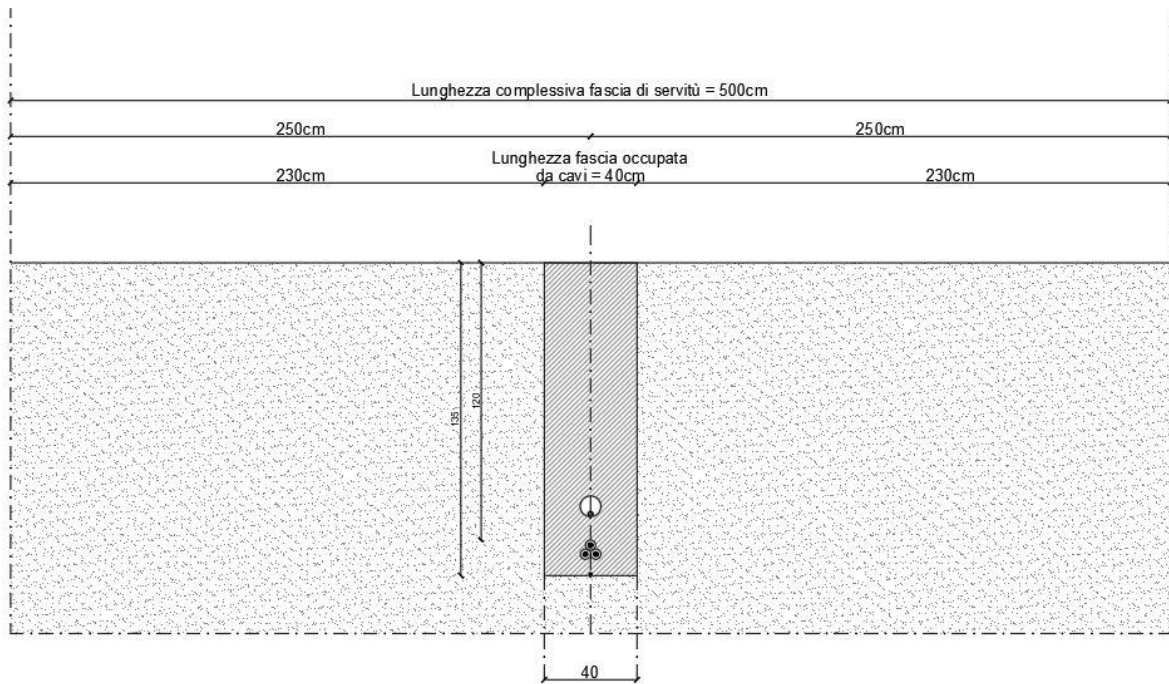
Sezione tipo scavo e fasce di rispetto per vincolo di servitù cavidotto di collegamento tra i lotti
